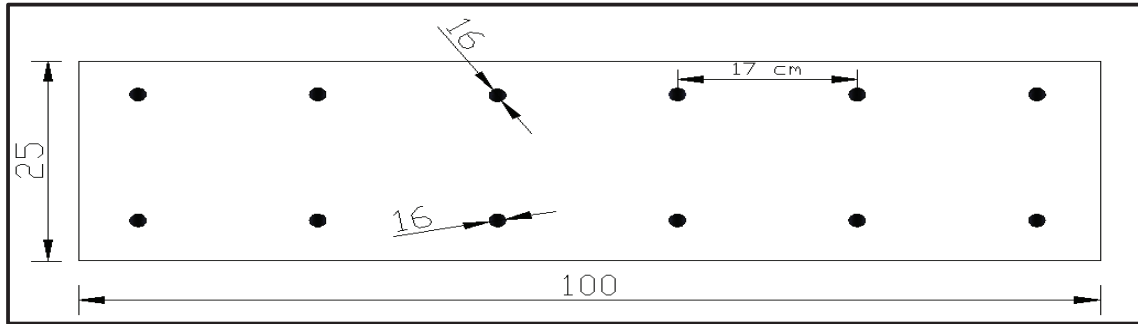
Schéma de ferrailage transversale de la dalle
